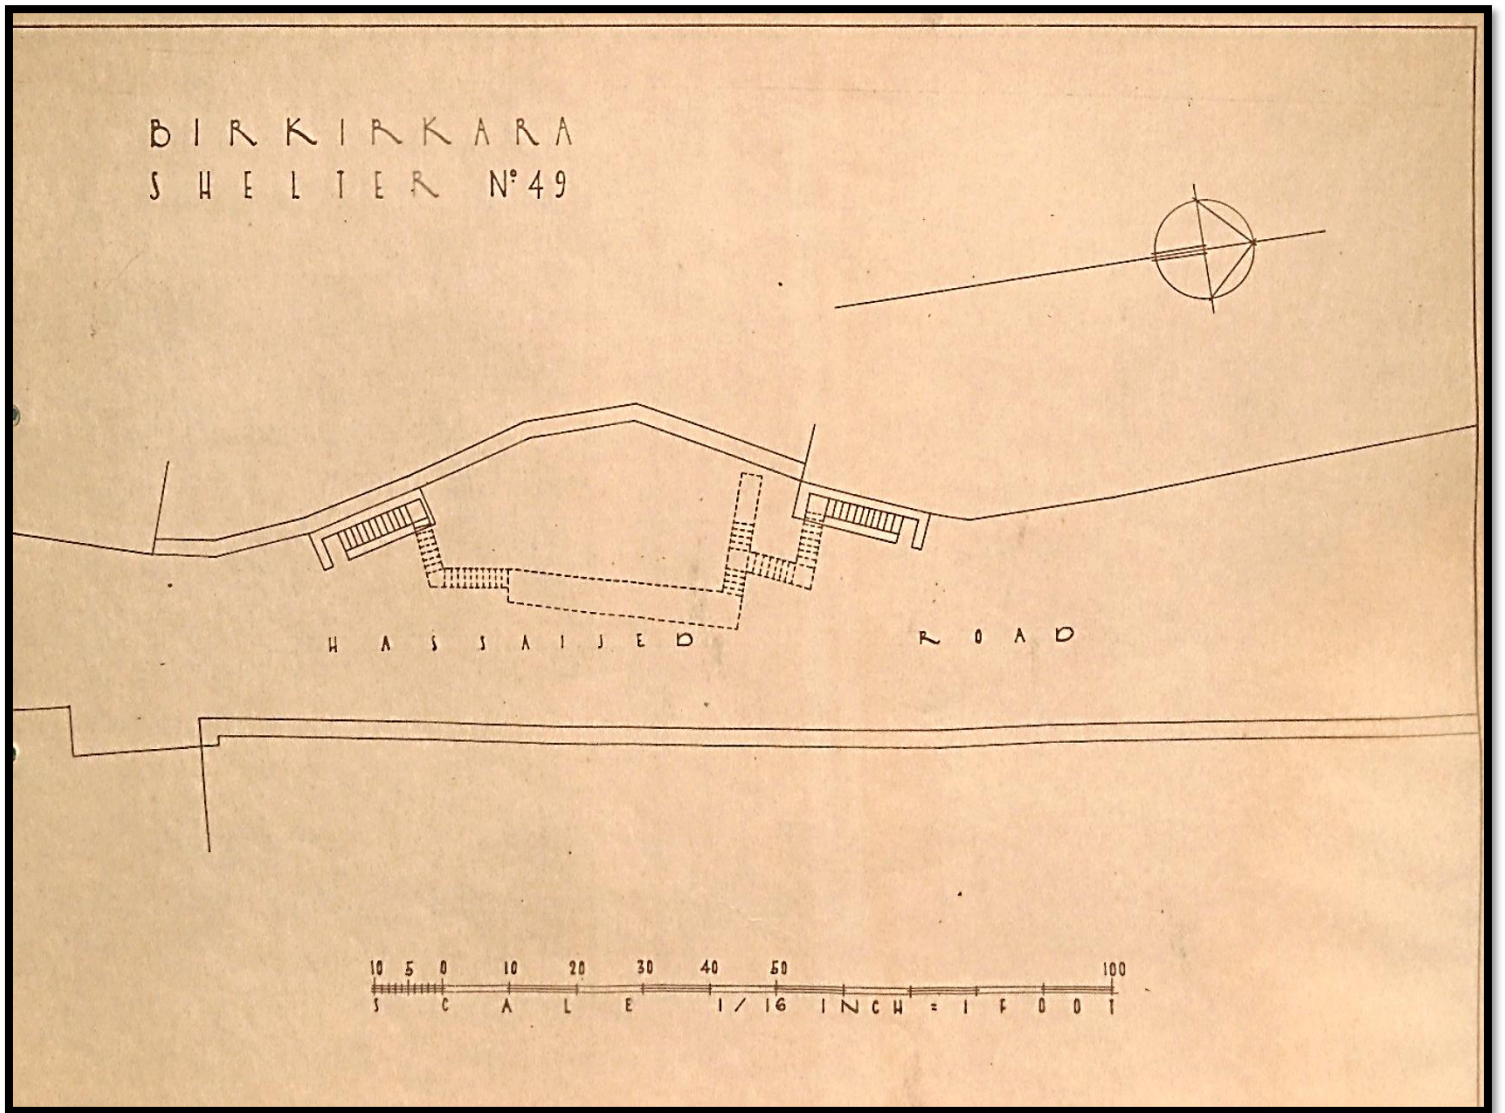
Planta do Abrigo nº49 "Hassajjeo Road"
